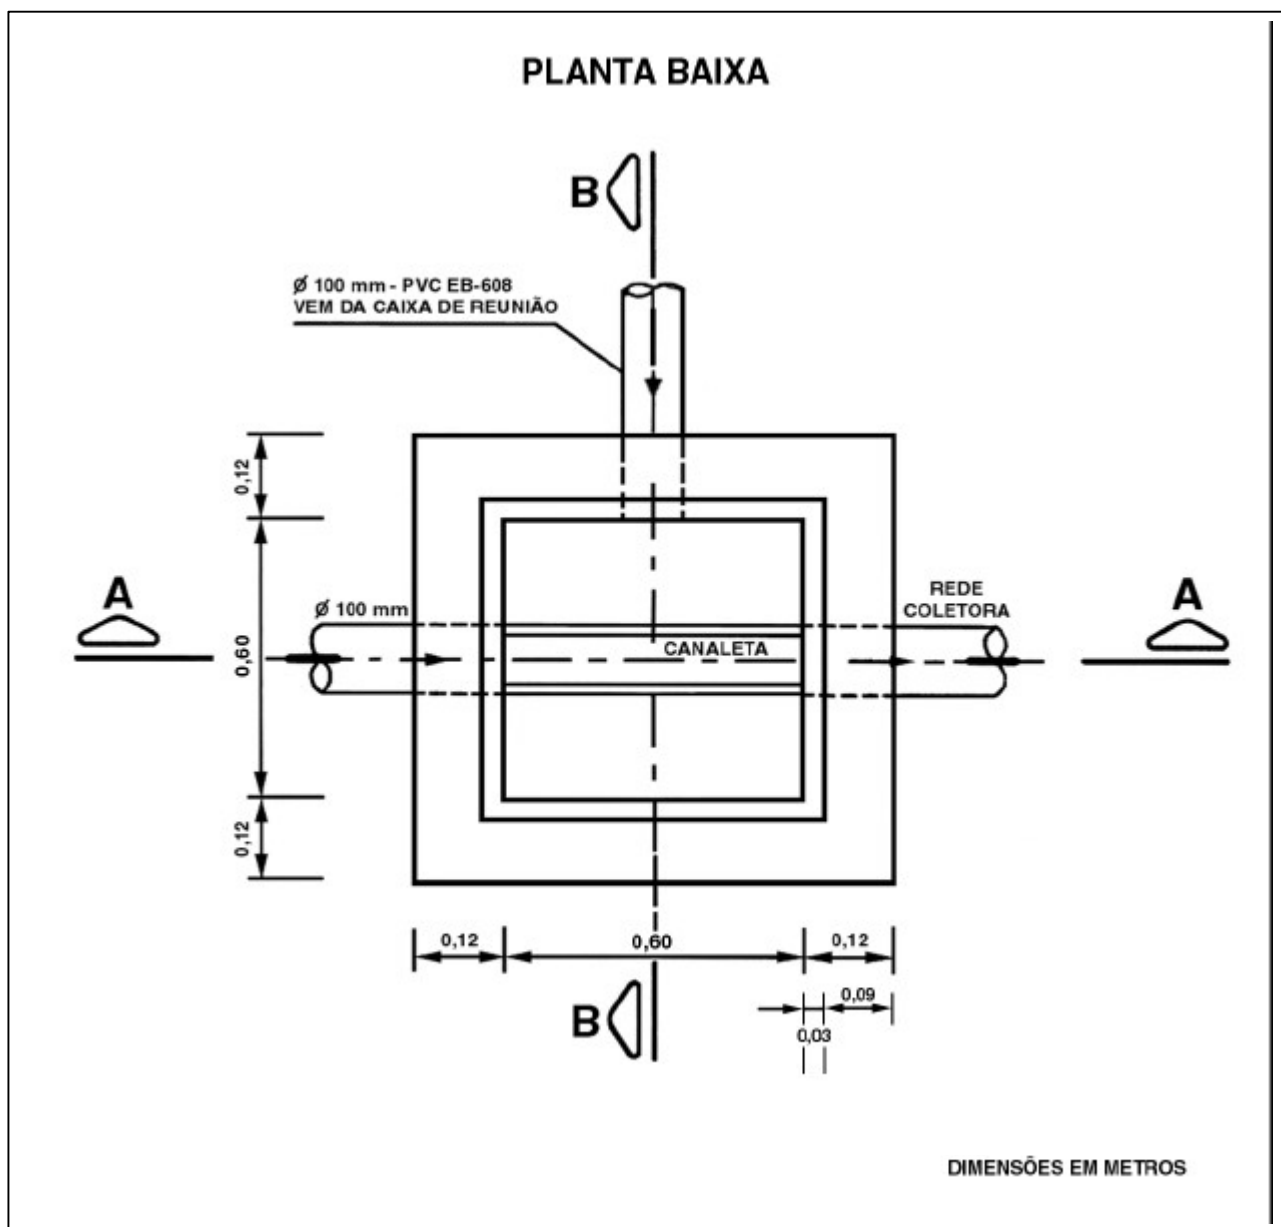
Caixa de Passagem CP 60- 80 – Planta Baixa
